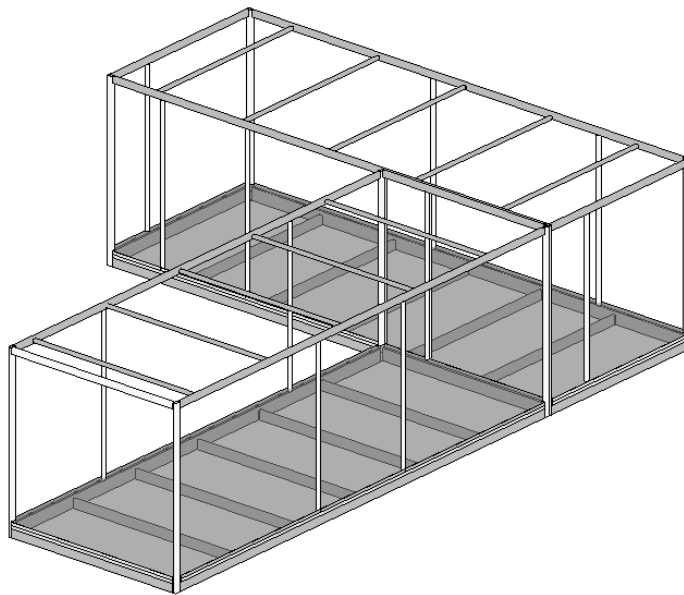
Vista Isométrica Estructura Acero y Hormigón Casa Cero.
